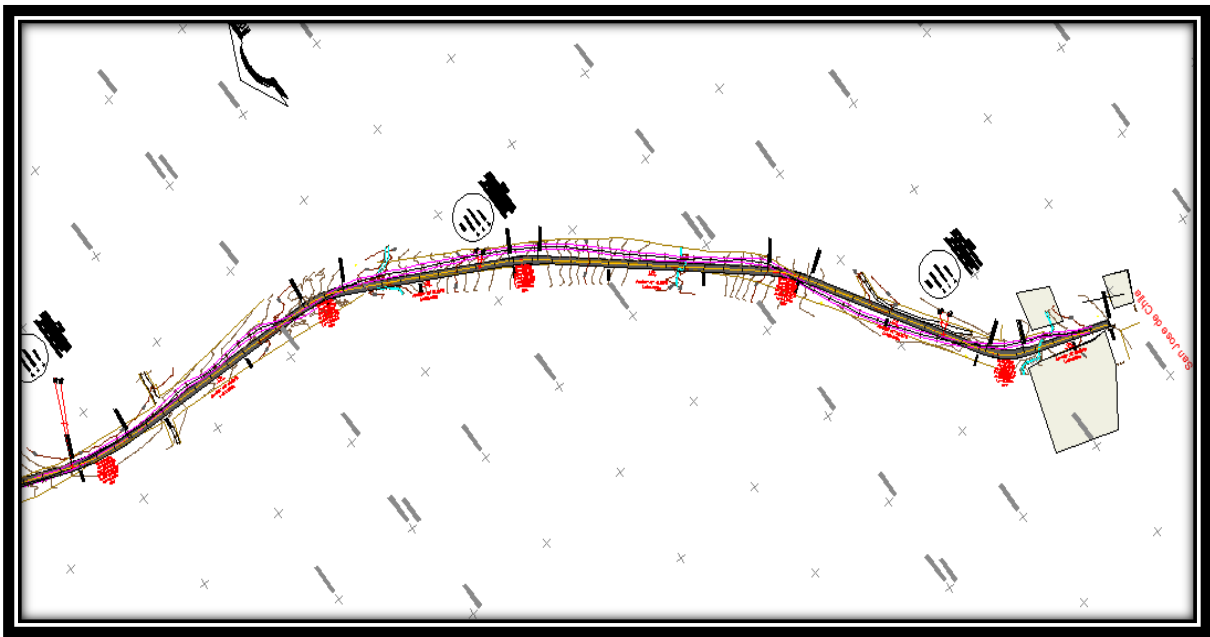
Planta general del km 22+700.000 al km 23+641.070.
